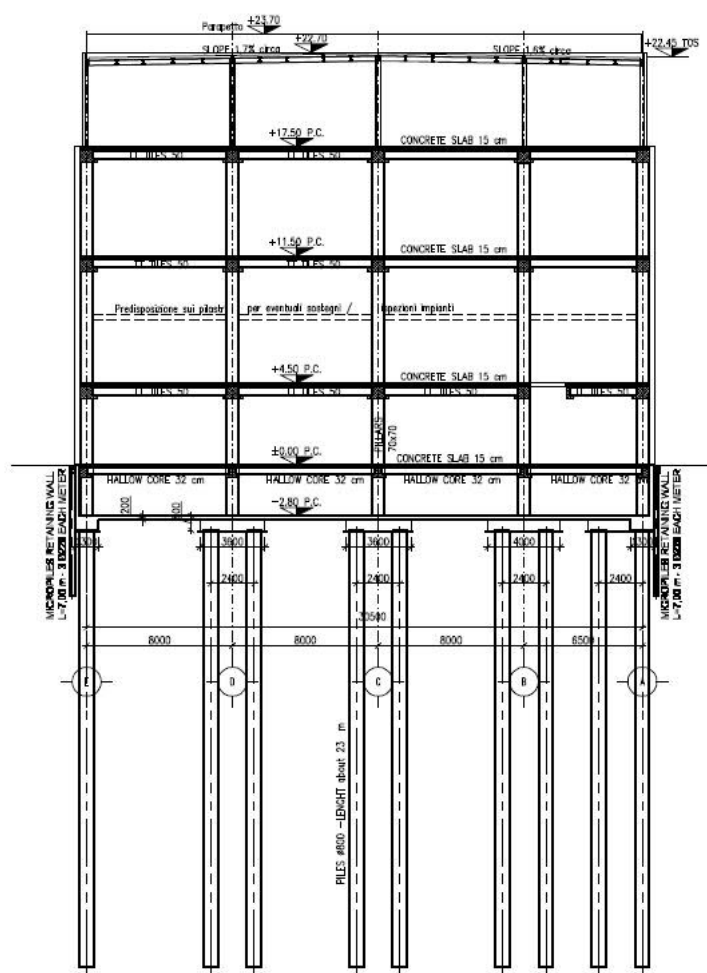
SEZIONE DELL'EDIFICIO CON FONDAZIONI PROFONDE
